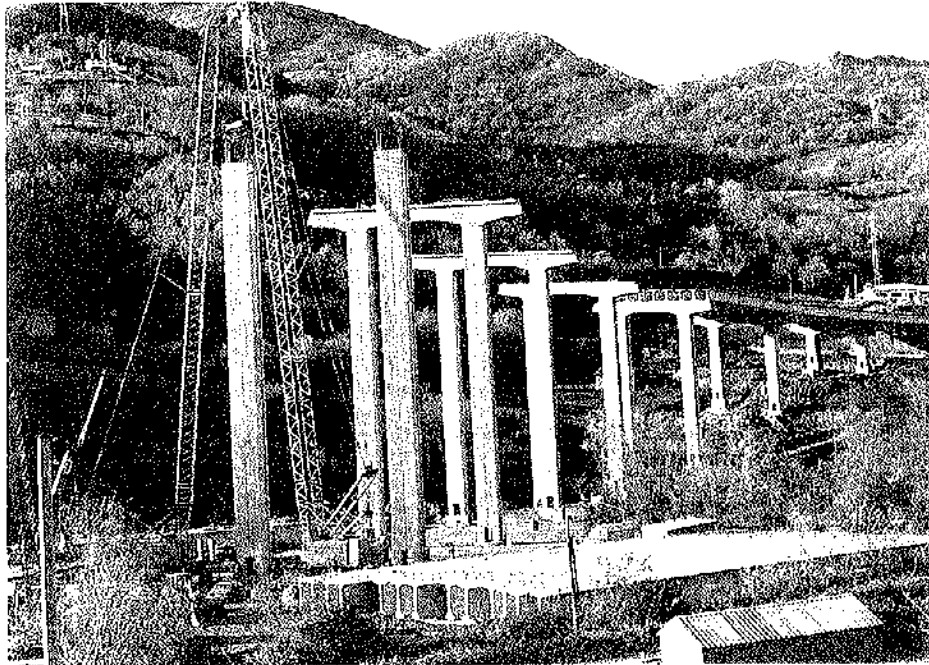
Viaducto del Huerna en la autopista Campomanes-León. Altura rasante sobre el terreno:  $\approx$  40 m. Pilas totalmente prefabricadas.
